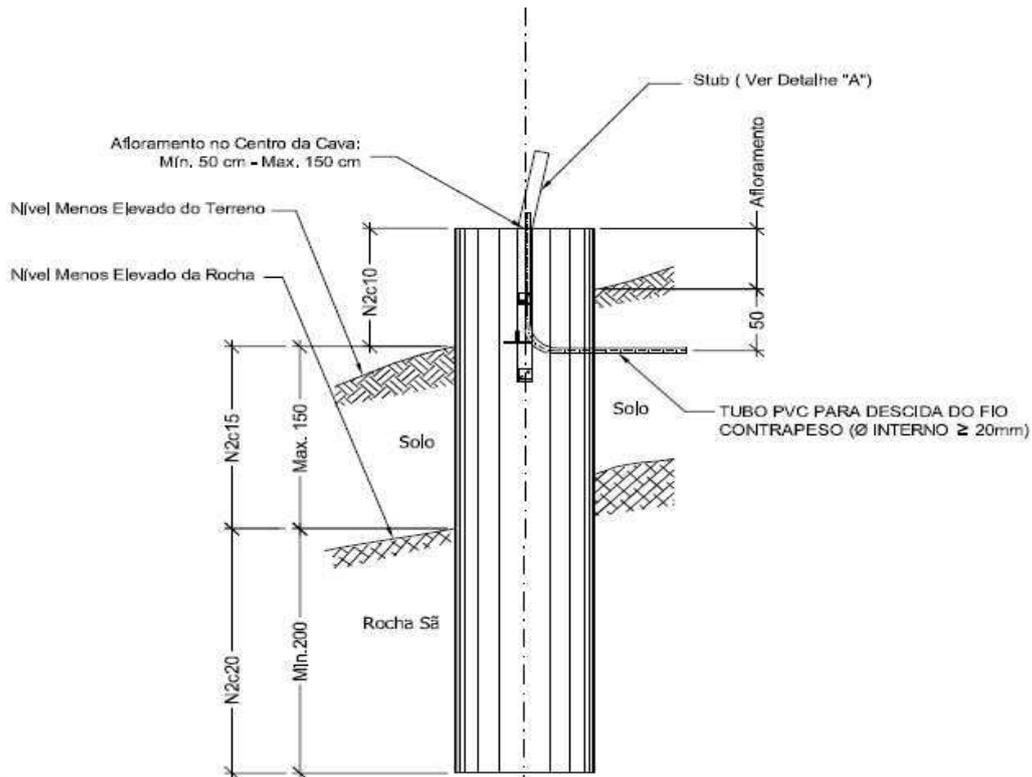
Detalhe da escavação de uma estrutura A21D (Chesf, 2009).
